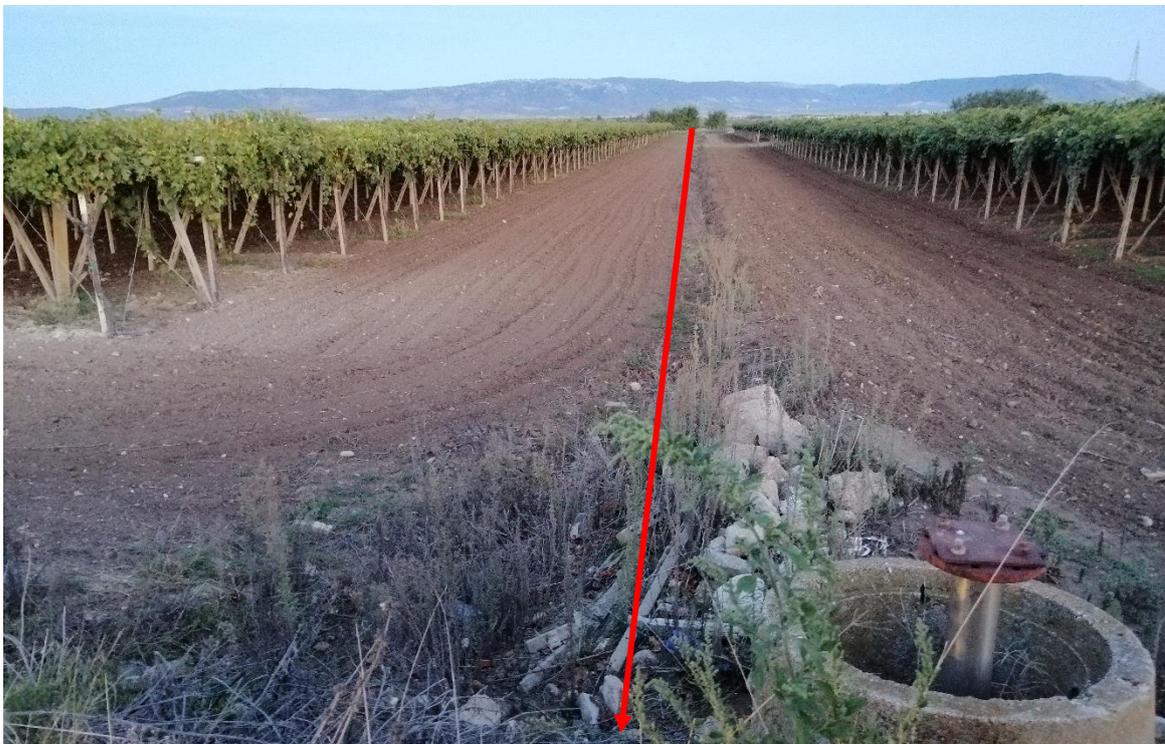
Passaggio in corridoio dentro vigneto (contro senso-gas) e strada di accesso
